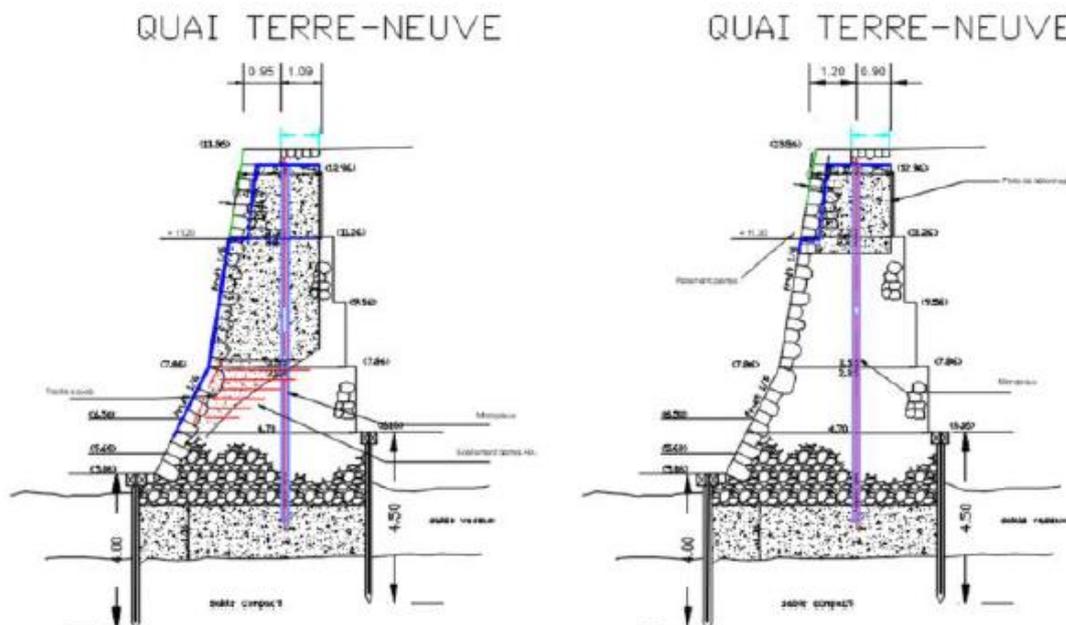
Coupe de principe des travaux de la solution n°1. Source : ANTEA
